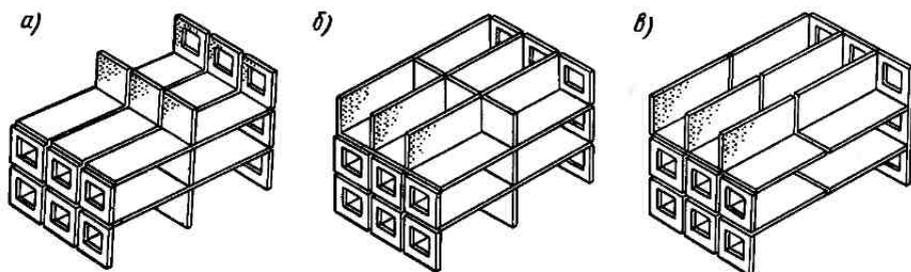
Конструктивные стены бескаркасных крупнопанельных зданий
